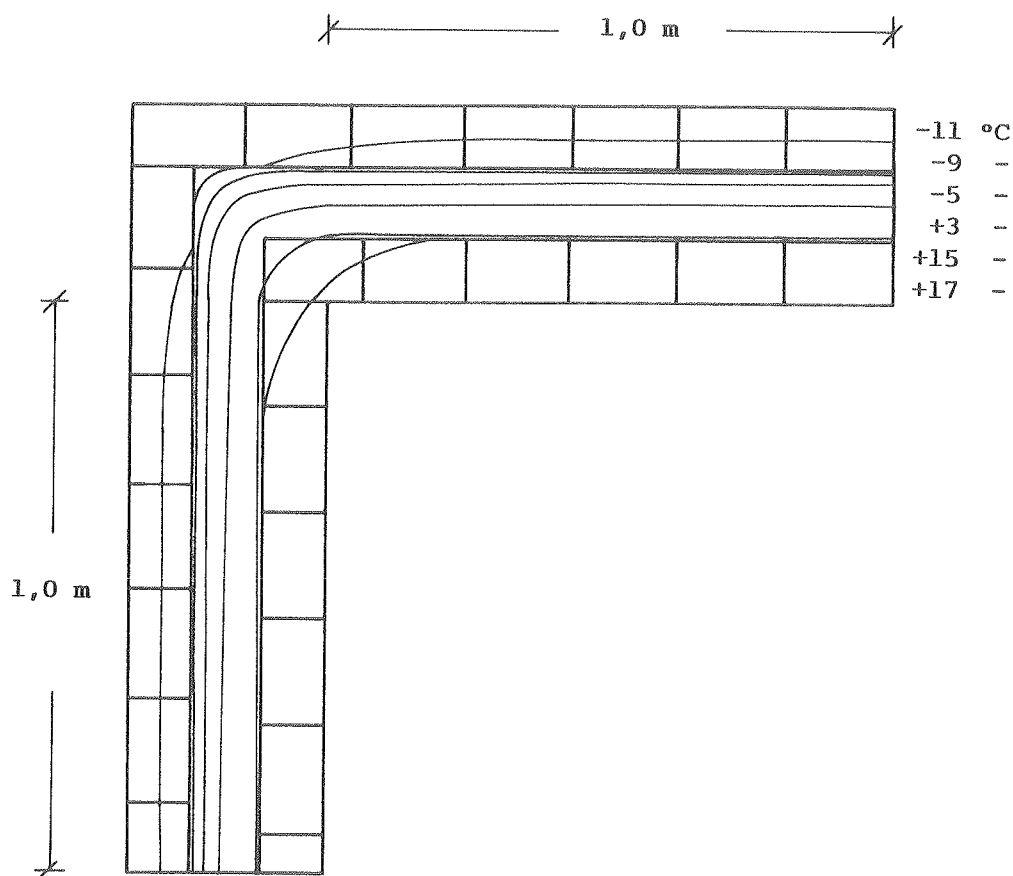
Varmestrøm gennem hjørne - beton-isolering-betovæg.
